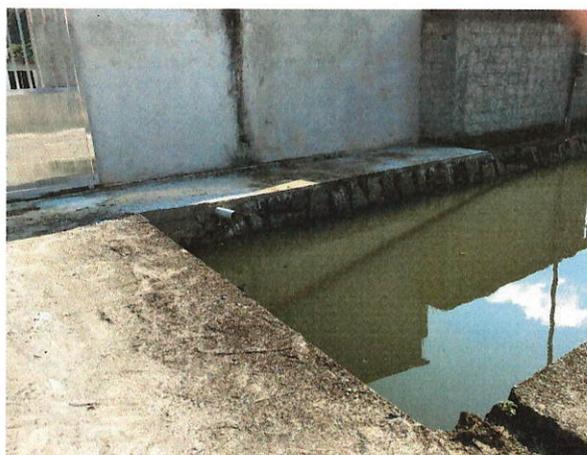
Rua Santa Madalena, tirada próximo ao canal.
